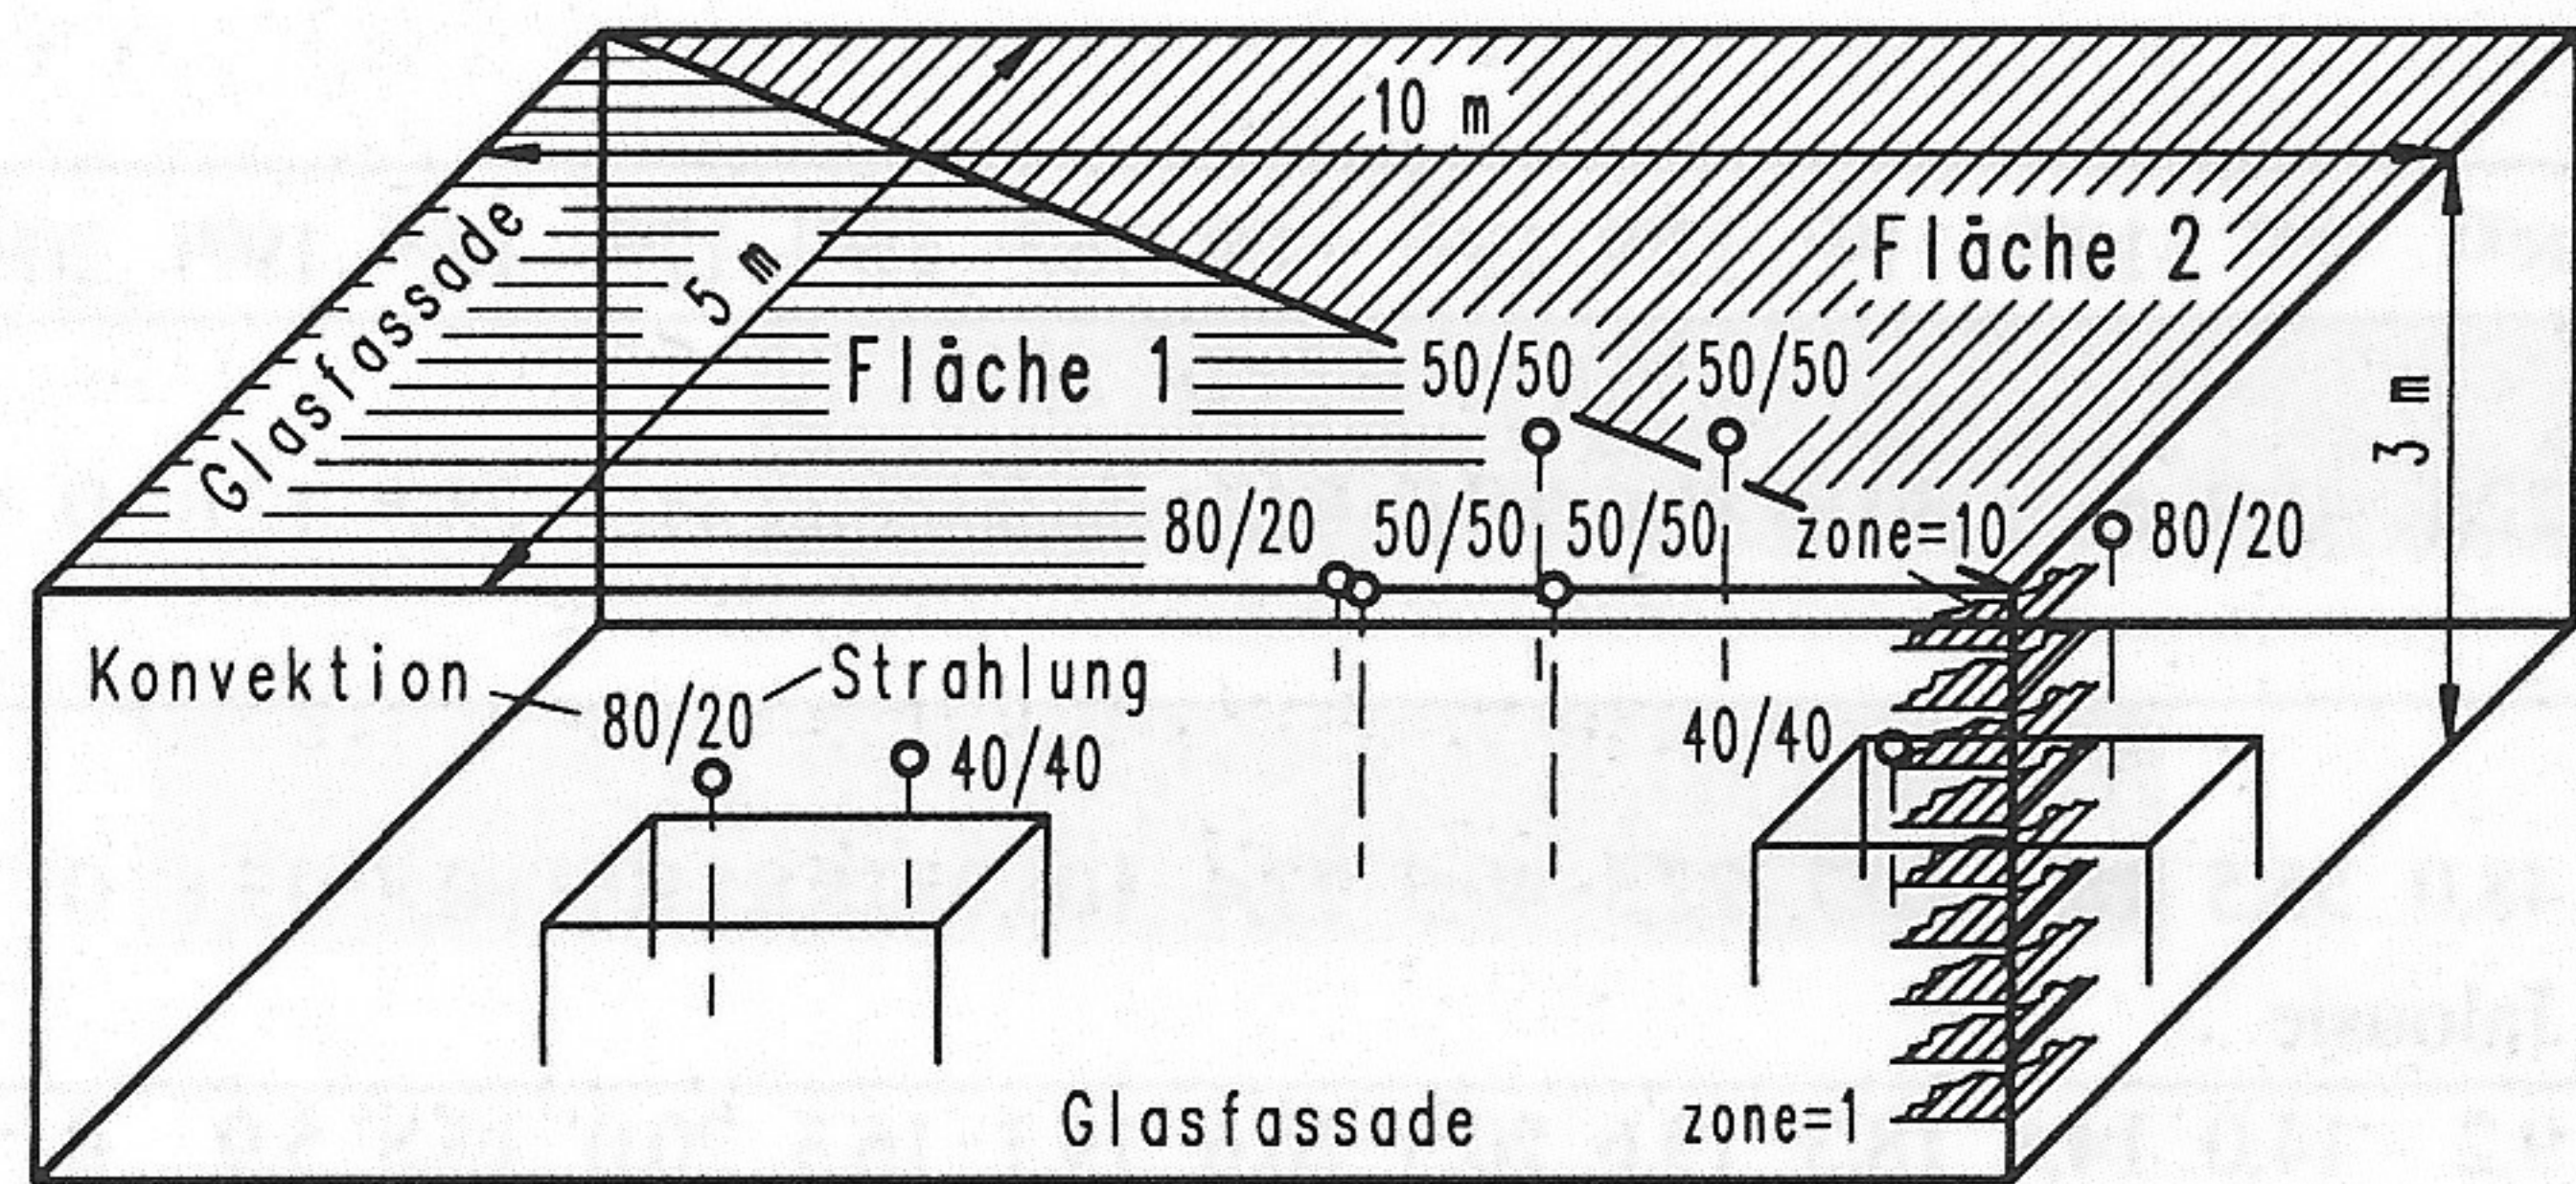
Eckraumbüro mit zwei Vollglasfassaden, neun inneren Wärmequellen, einer Kühldecke (Vollflächenbelegung) und Quelllüftung mit dreifachem Luftwechsel.
